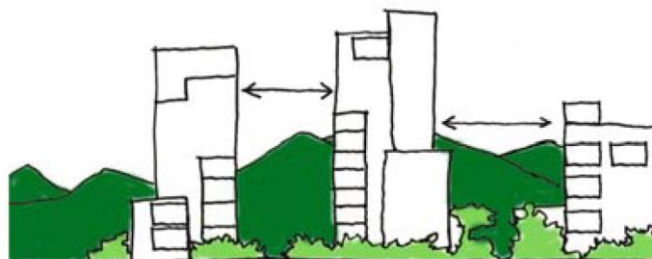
16: Règle d'implantation des bâtiments, vue en élévation, (© Cairns Plan 2016 1)
